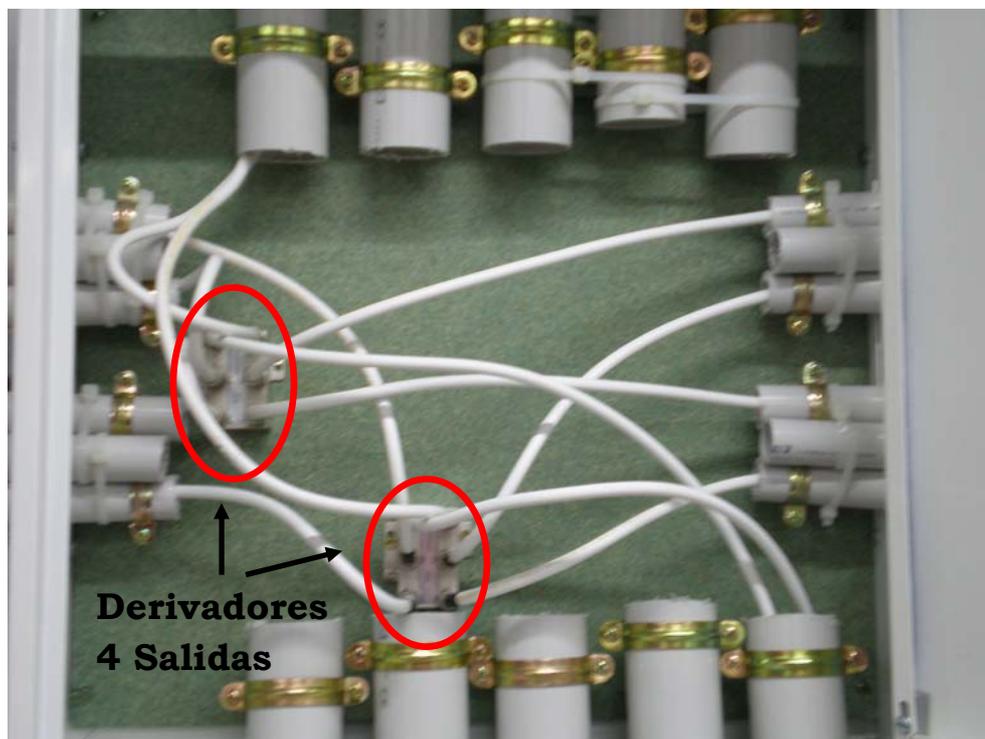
Interior de un registro secundario de una planta de 4 viviendas
